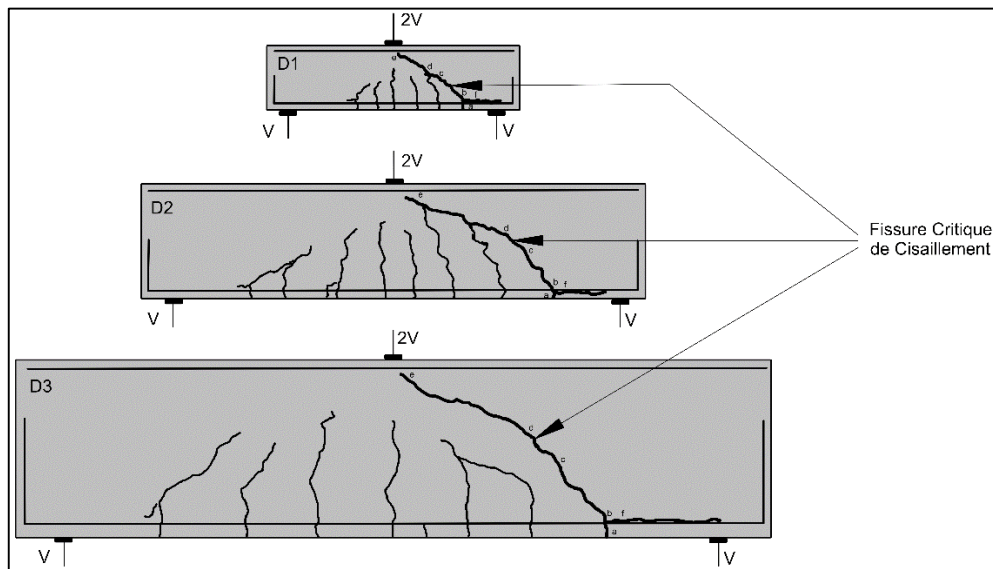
Profils de fissurations pour les trois poutres.
